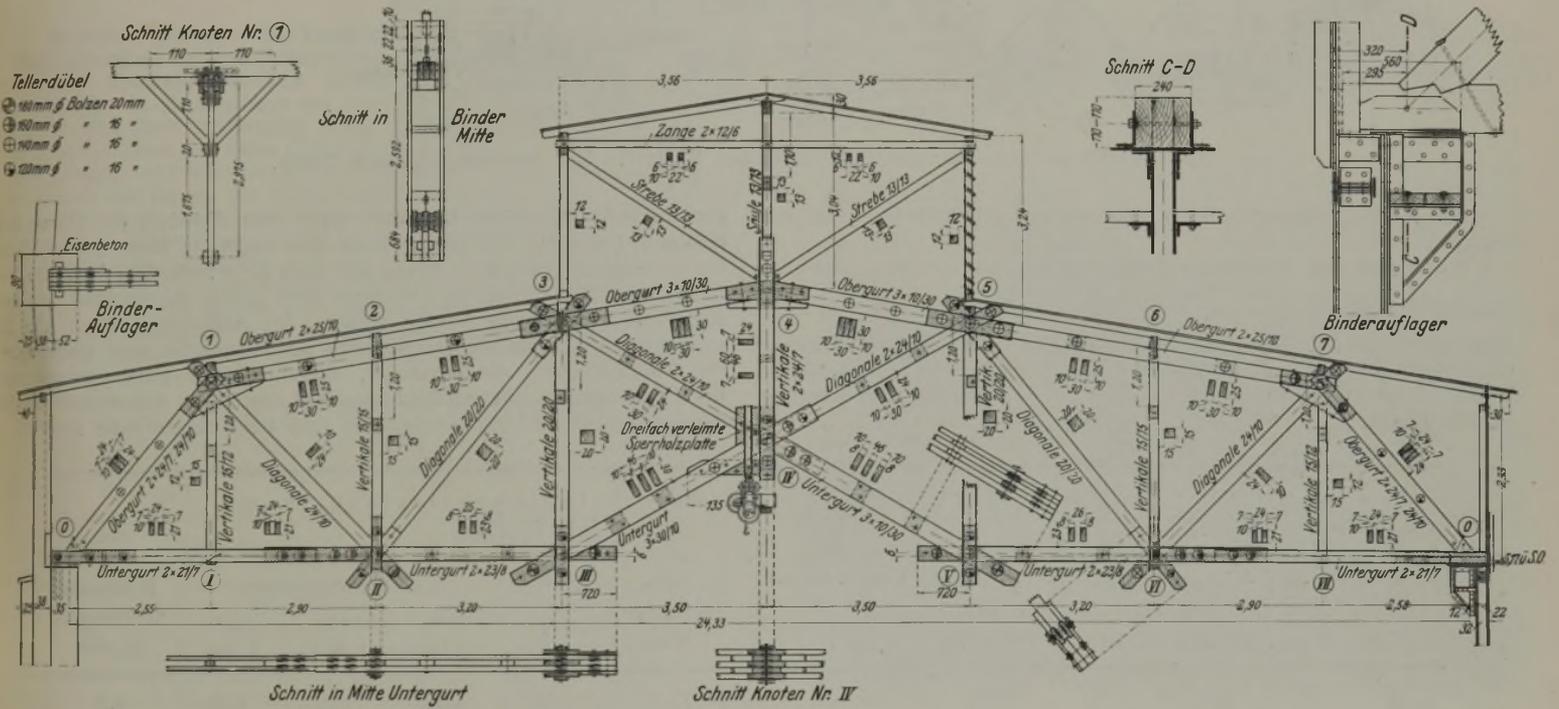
Ausführungszeichnung des Lokschrupens Mödrath.
